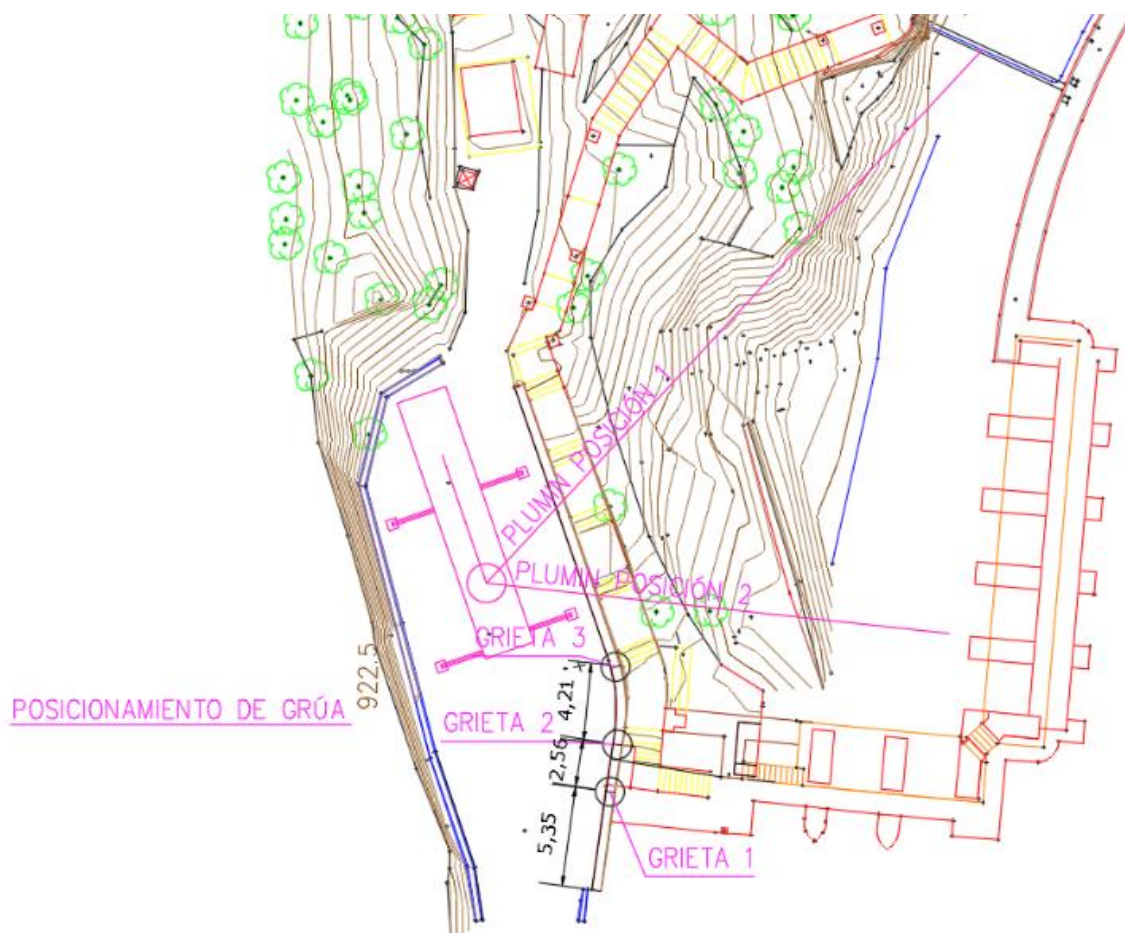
Ubicación de las grietas en la planta de la plataforma.
